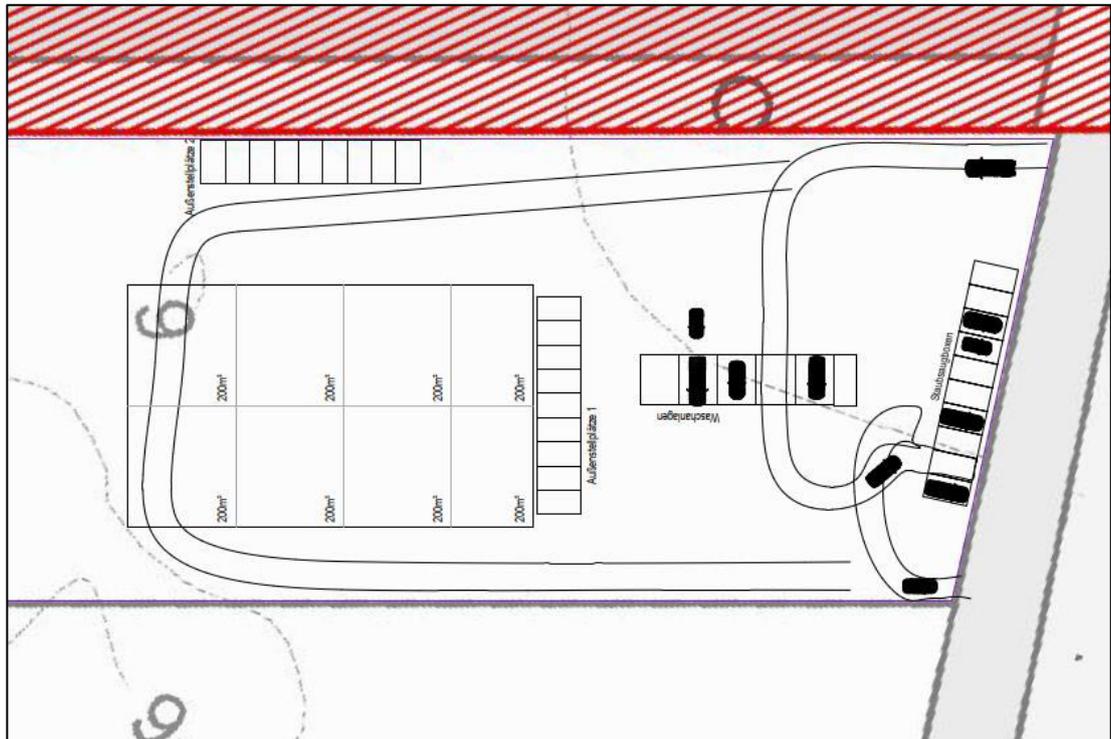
Übersichtsplan mit Lage der geplanten Halle (Quelle: Unterlage /U2/)
